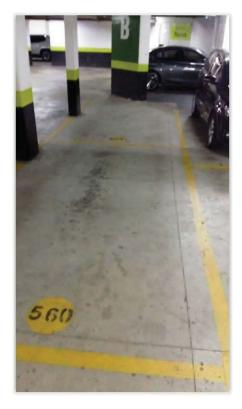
Vista geral das vagas na garagem do imóvel vistoriando.
